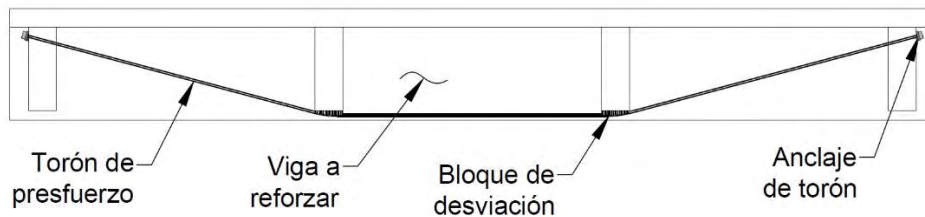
Sistema tipo de reforzamiento con presfuerzo externo
